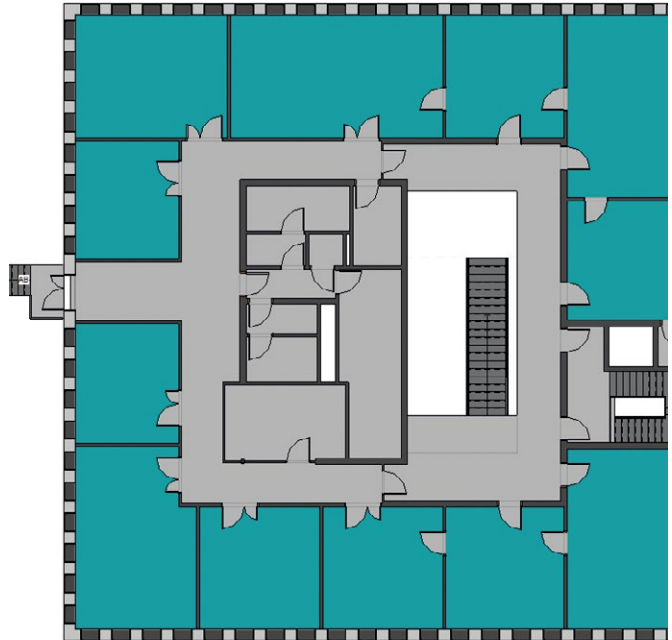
Grundriss des Beispielbürogebäudes (gekühlte Räume Türkis)
